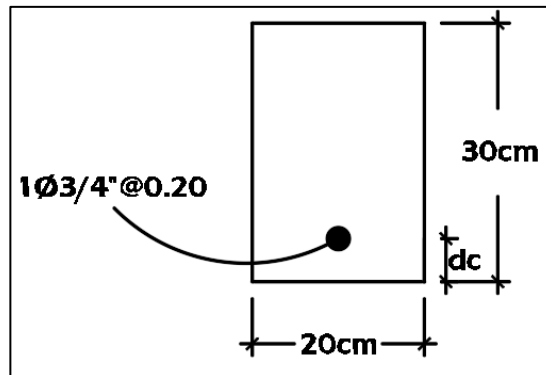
Distancia efectiva para la revisión por fisuración
